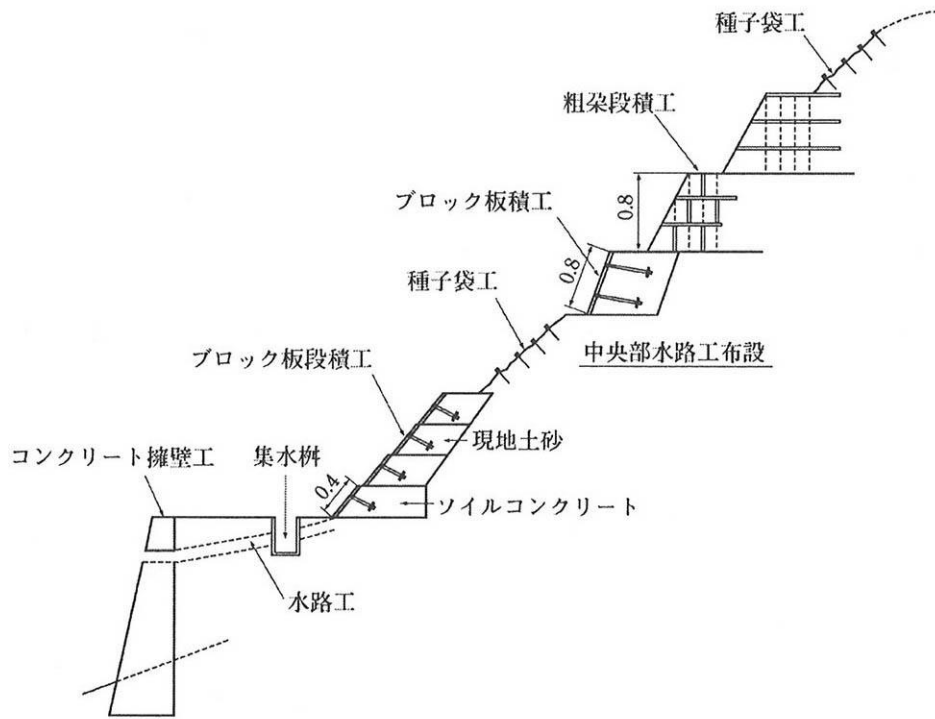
土留工を主とした山腹工(施工例)断面図
